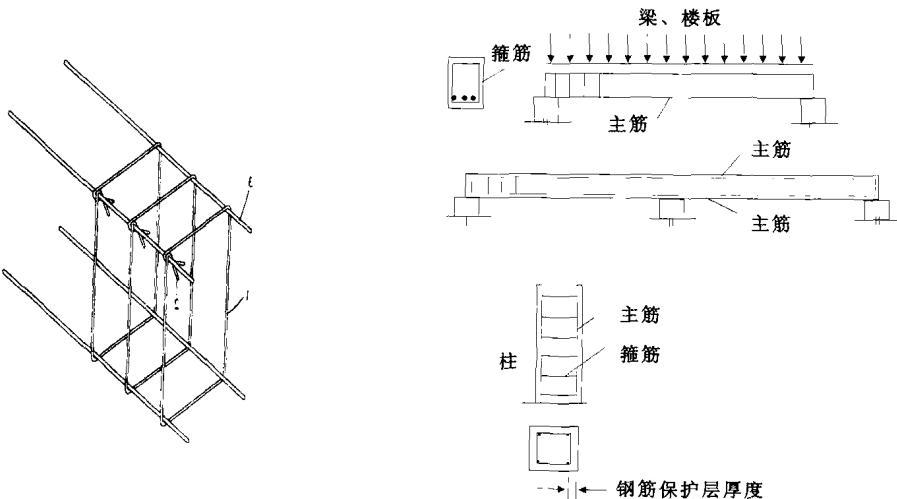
钢筋混凝土梁、柱（从上至下，简支梁、连续梁、柱）
